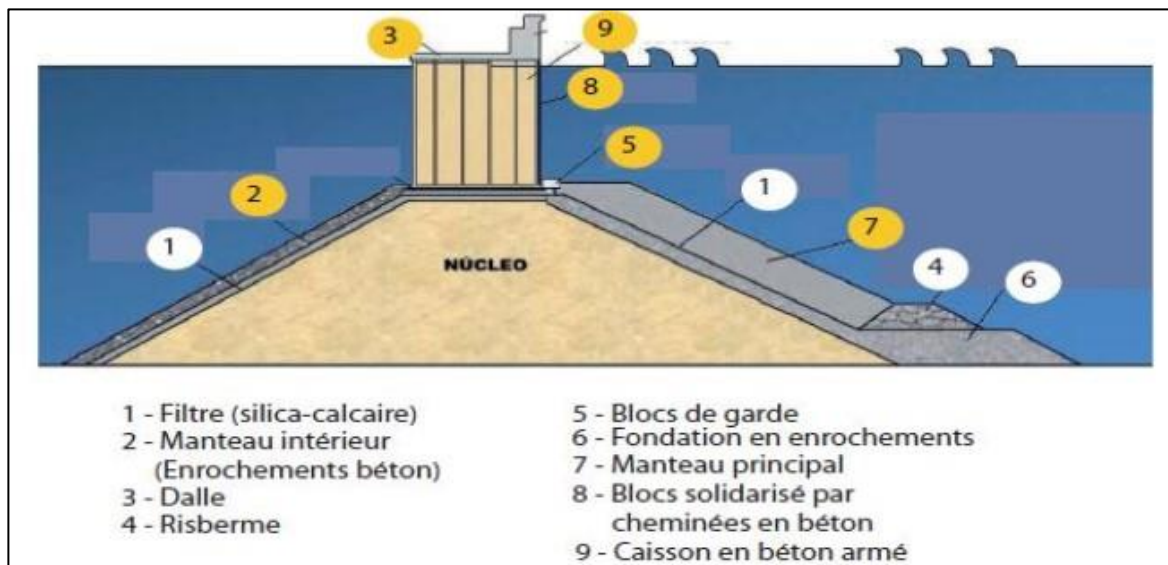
Schéma d'une digue mixte (Xavier Lasserre 2008)
